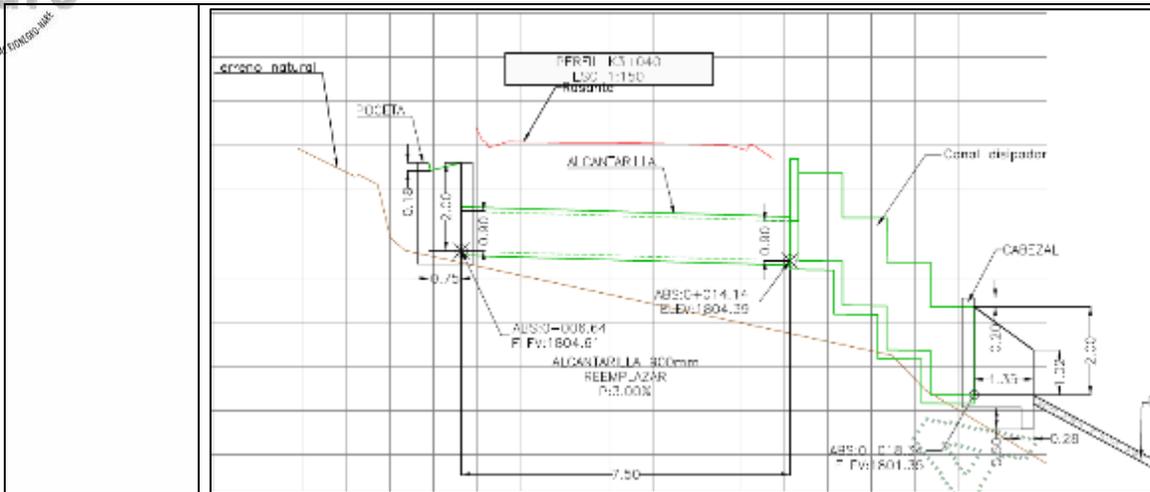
(41)					Tipo de la obra	Tubería abscura K02+957
